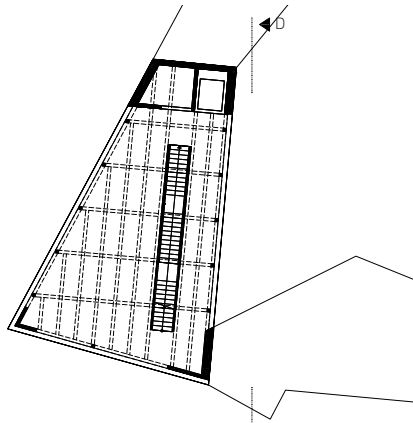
Grundriss Gewächshaus 1.OG +6,70m
